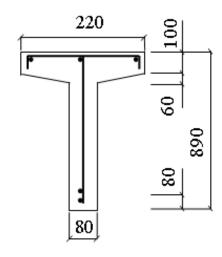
Схема приложения нагрузок и основные размеры балки покрытия *Расчет*.
